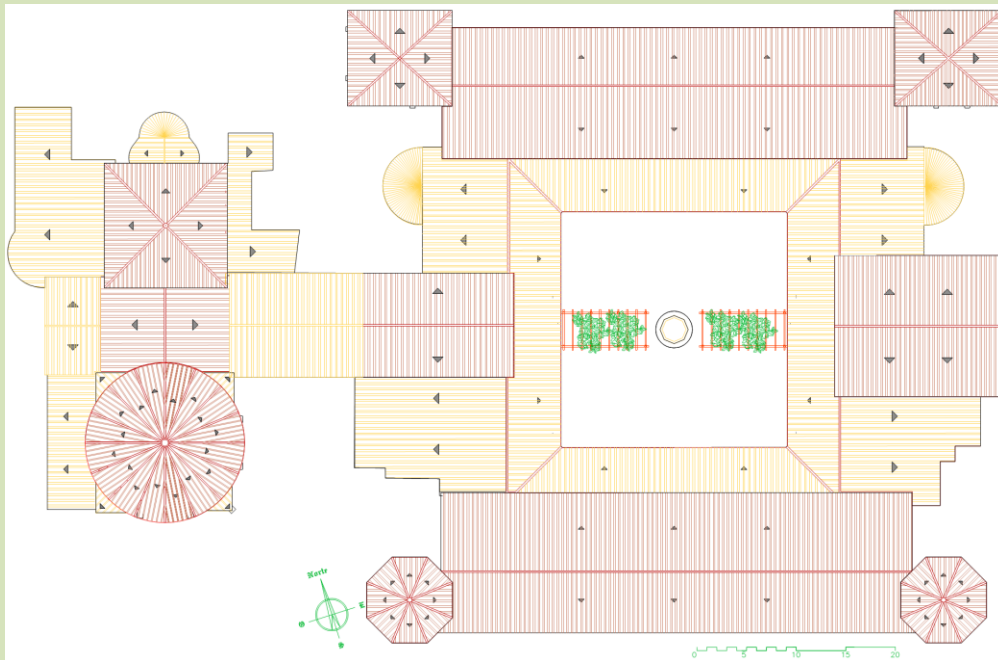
Planta de cubiertas (en color oscuro las zonas de mayor altura). Reconstrucción ideal. CGS.
